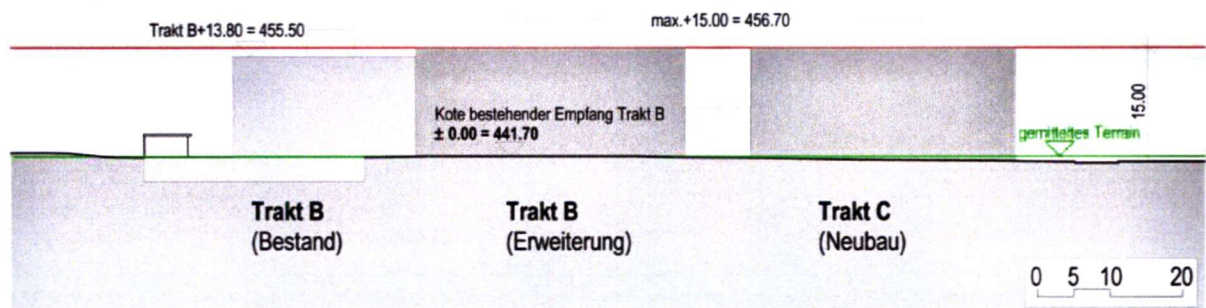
mittlere Terrainhöhe und zulässige Gebäudehöhen Ost-West, Mst. 1:1000 (Quelle: BGP Architekten)
